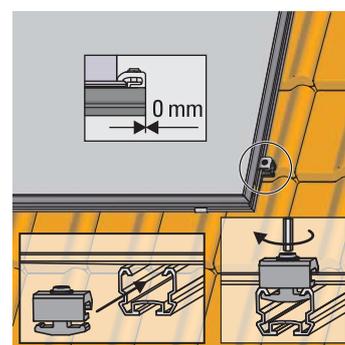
Controllare la posizione di montaggio corretta, inserire la piastrina di bloccaggio singola nella guida di montaggio inferiore e avvitare saldamente
